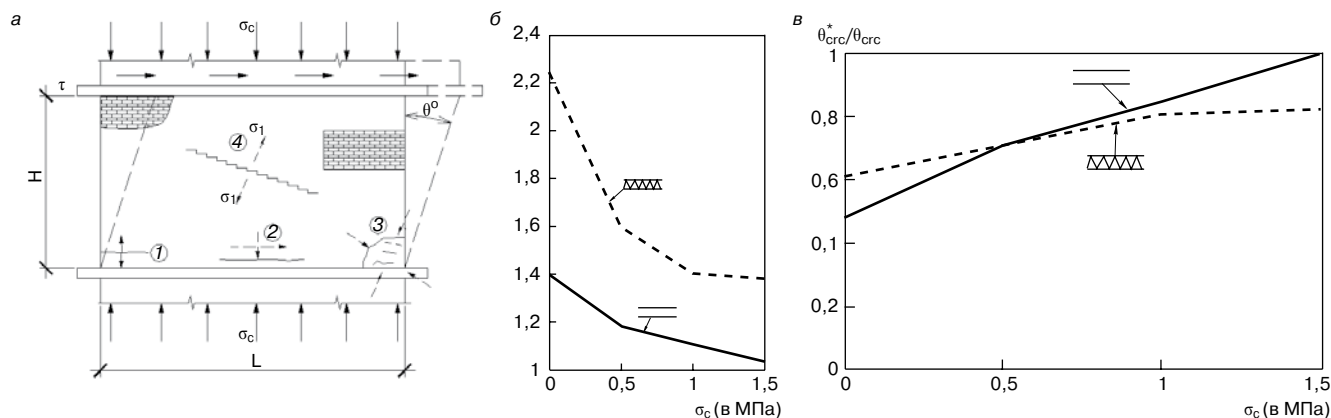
Механизмы разрушения стенового каменного заполнения при перекосе в плоскости стен (а) и результаты испытаний армированных и неармированных образцов кладки на сдвиг сжатием (б, в)
